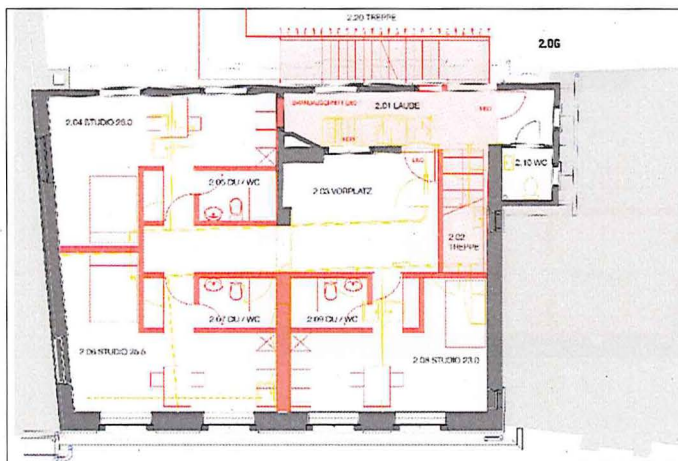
Grundriss Hotelgebäude, 2. Obergeschoss mit drei Studios
